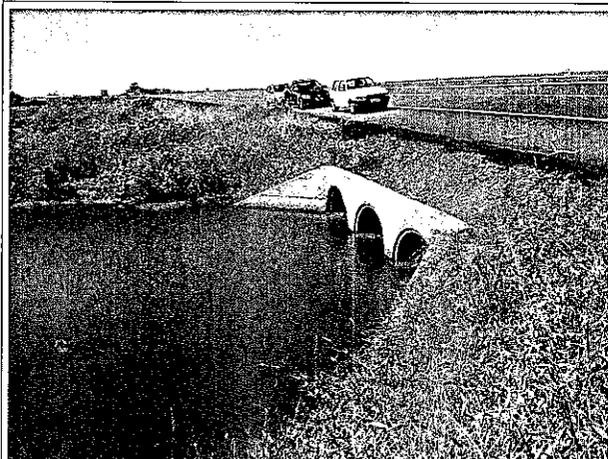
lado direito da rodovia, dispositivo instalado em área alagada.
